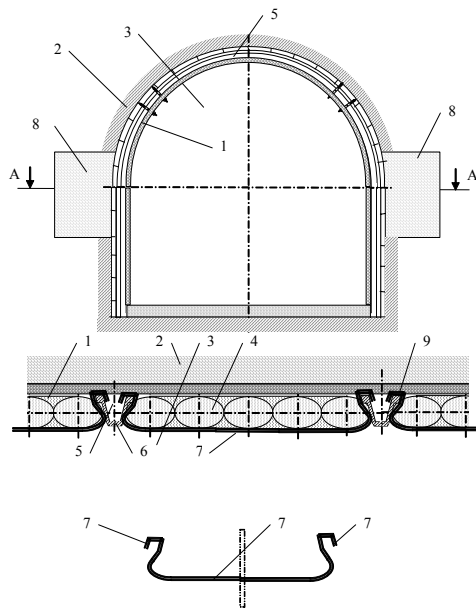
Принципиальная схема теплоизоляции стенок выработки
